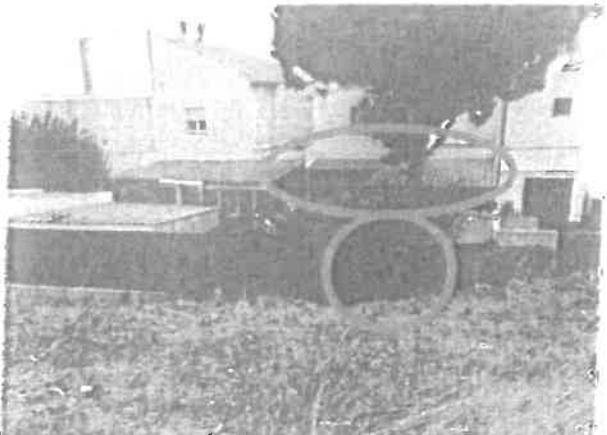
Anexo, telheiro e vão de porta para lote privado.
